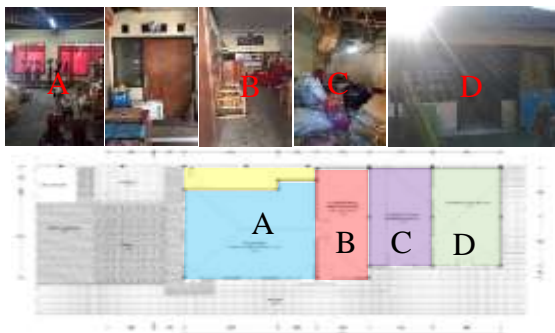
Sketsa Design Denah dan Tampak Bangunan
